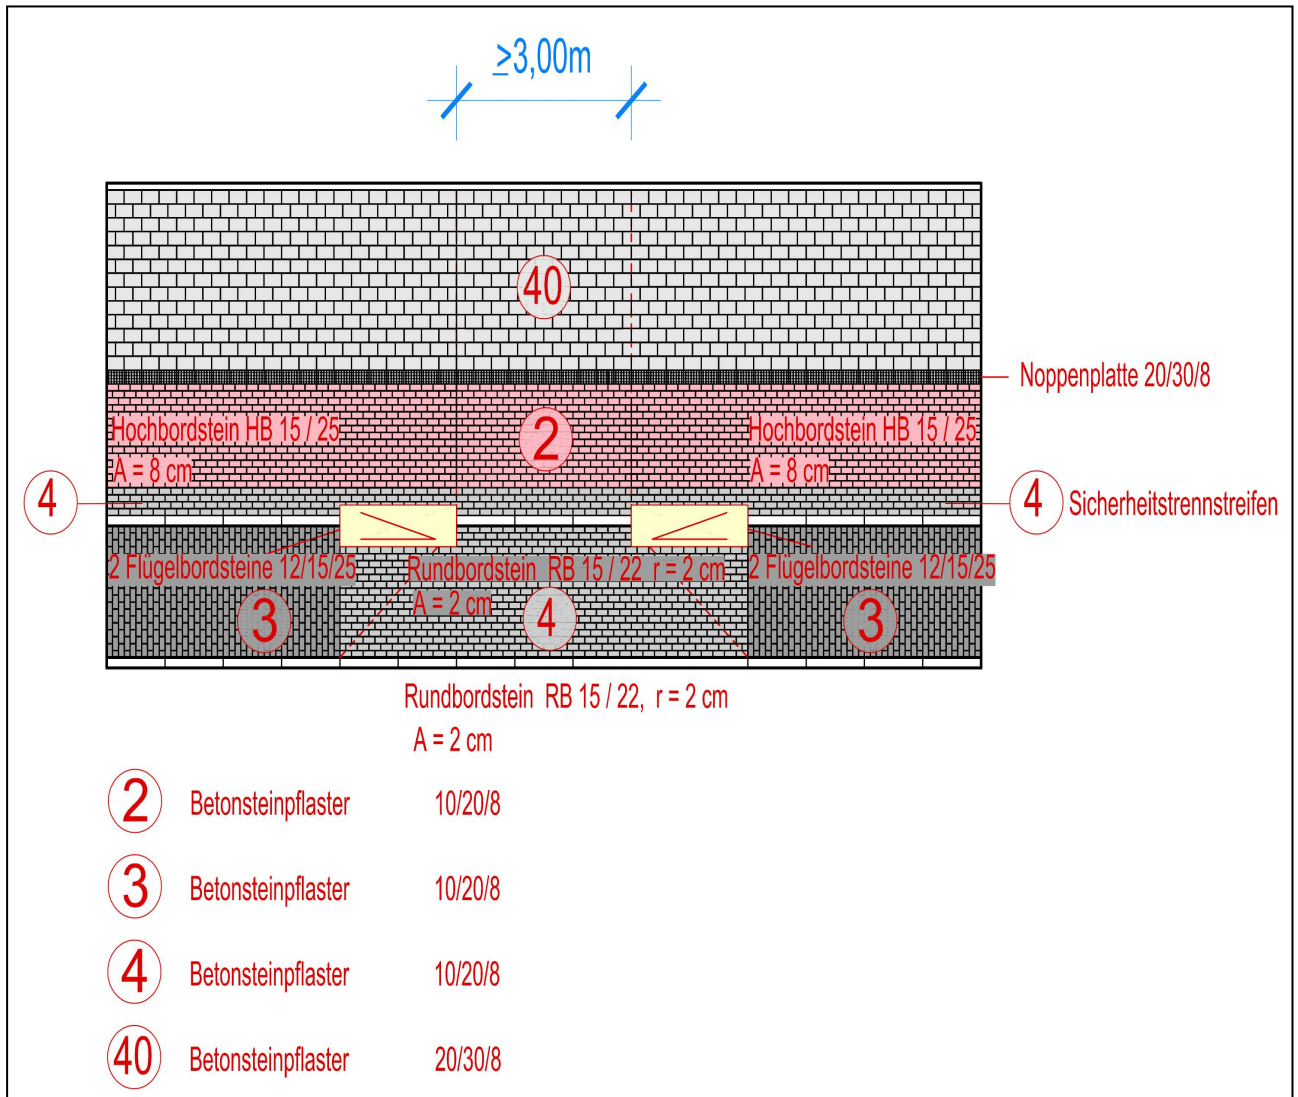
Grundstückszufahrt mit Radweg und Parkstreifen (Alternativlösung)
